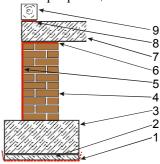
Гидроизоляция фундаментной стены на этапе строительства от влажности и влияния среды:
